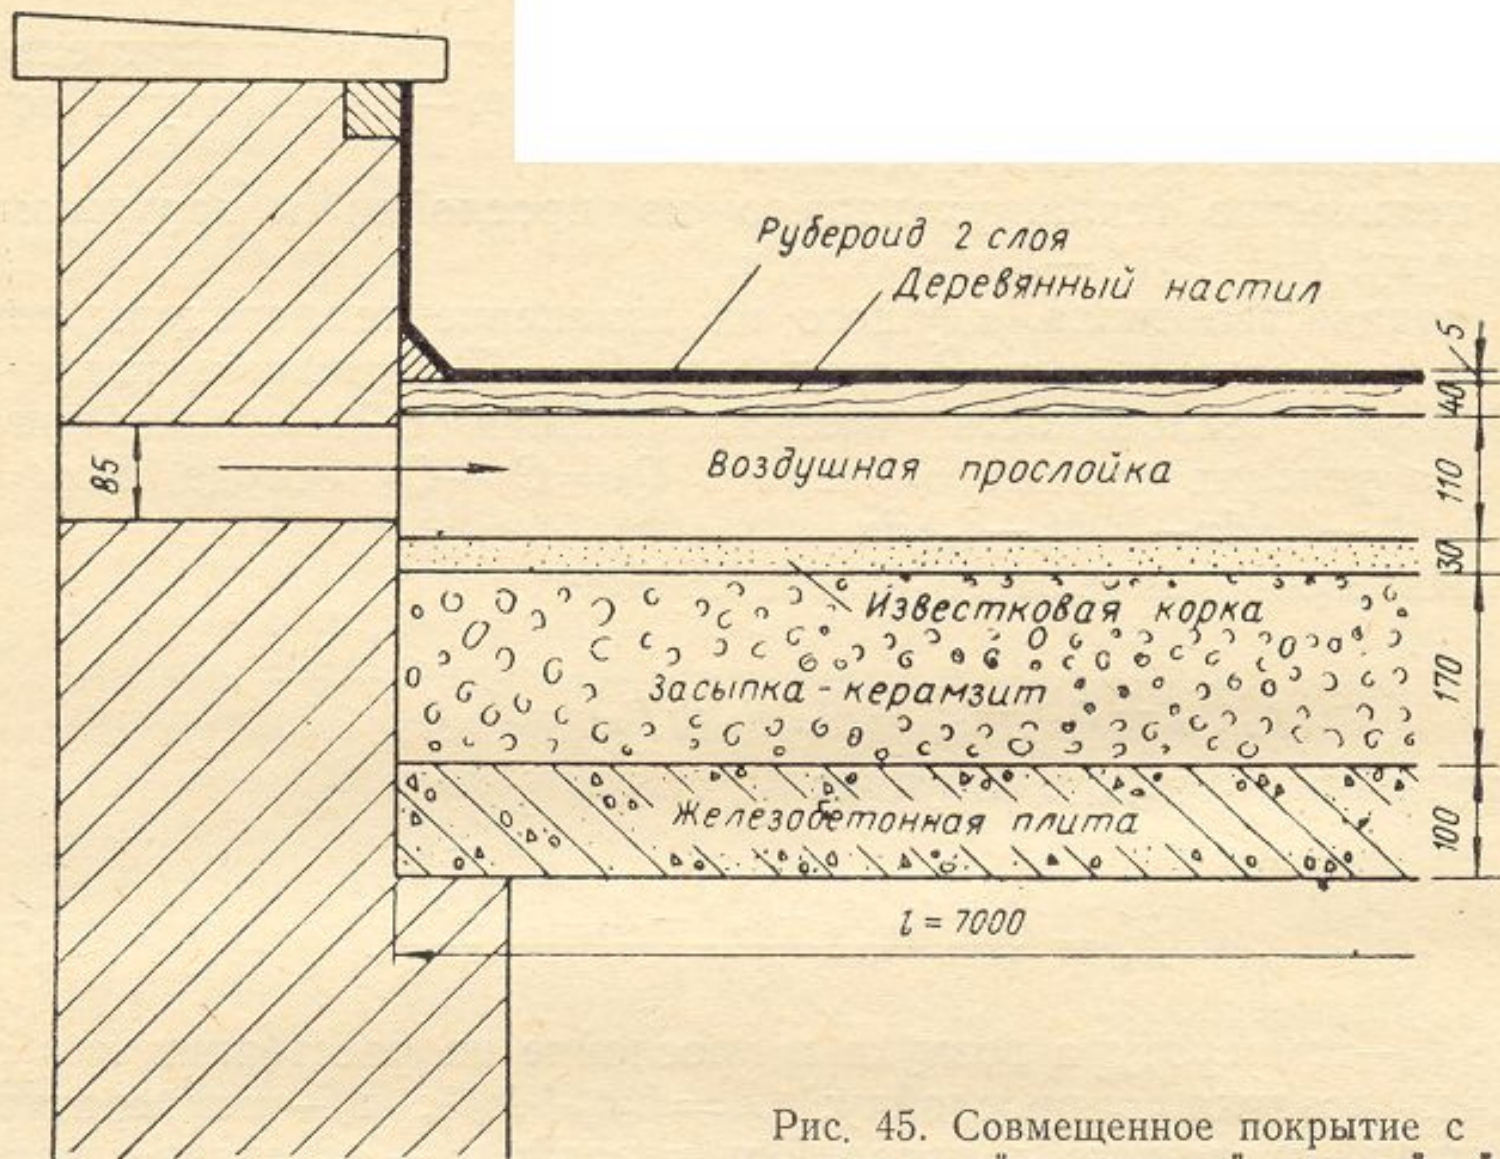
Совмещенное покрытие с вентилируемой воздушной прослойкой
